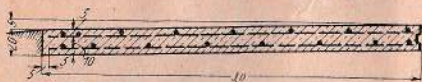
Doppelte Bewehrung mit Baustahlgewebe.
